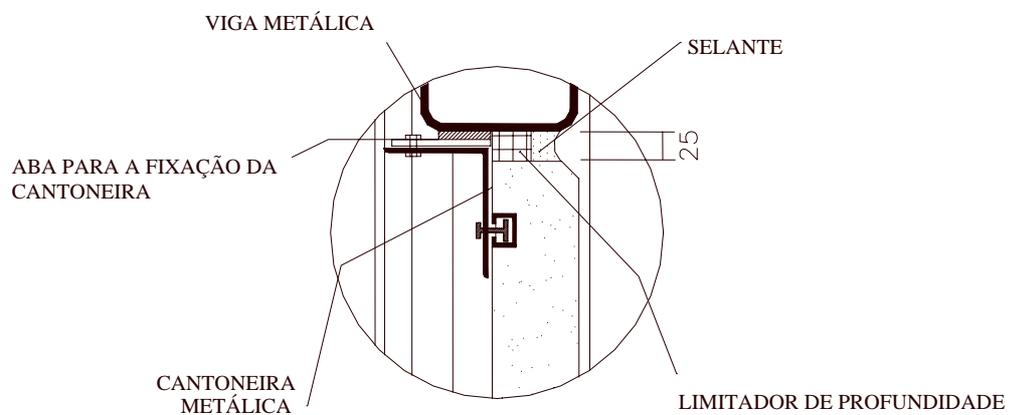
Detalhe A: fixação do painel na viga de borda.
